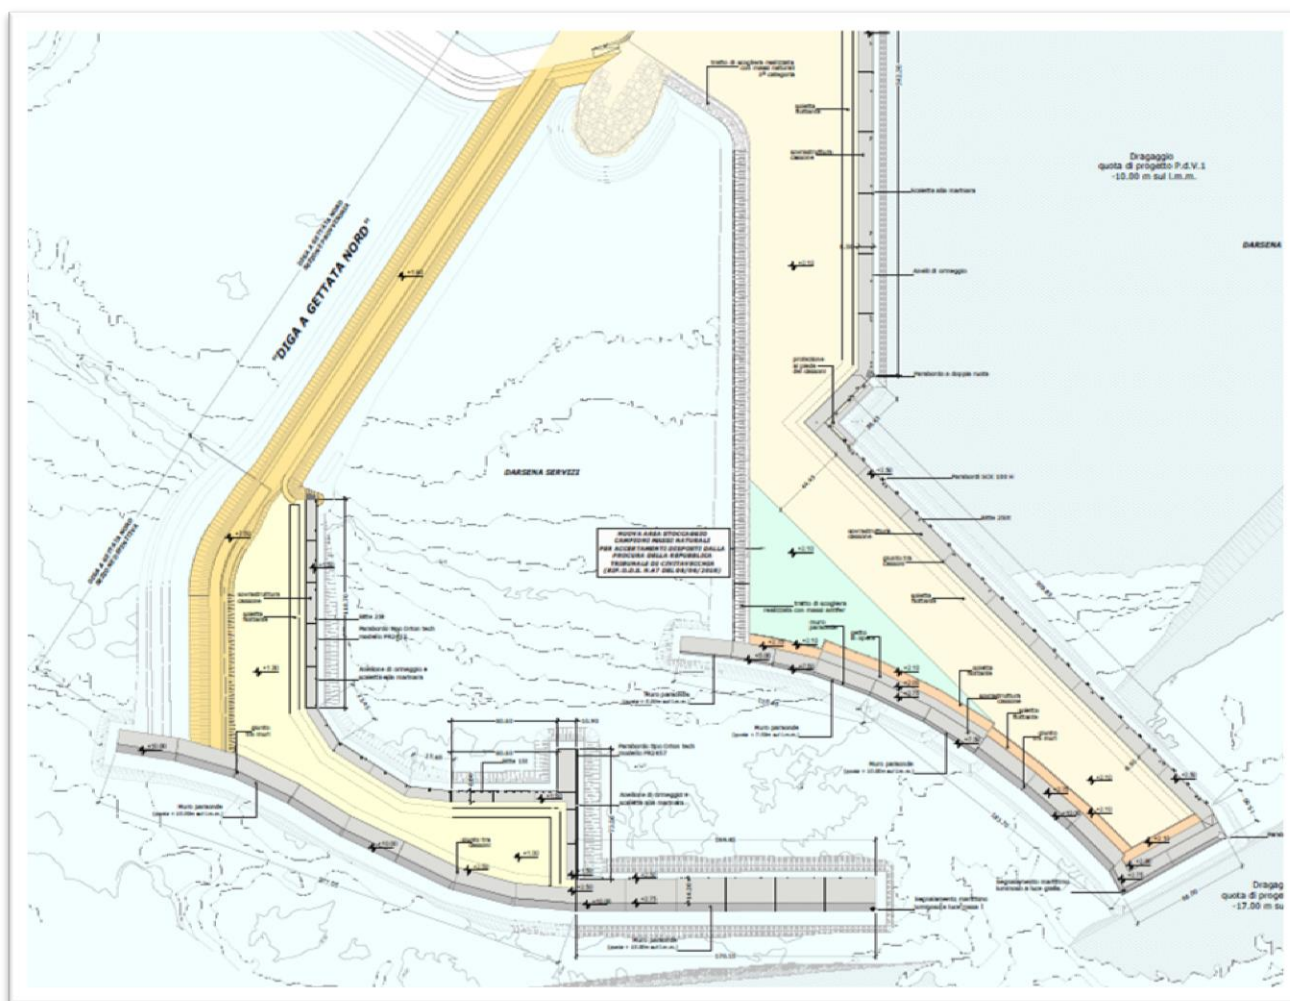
Stralcio planimetria di progetto Darsena Servizi (009 001 01AD)
